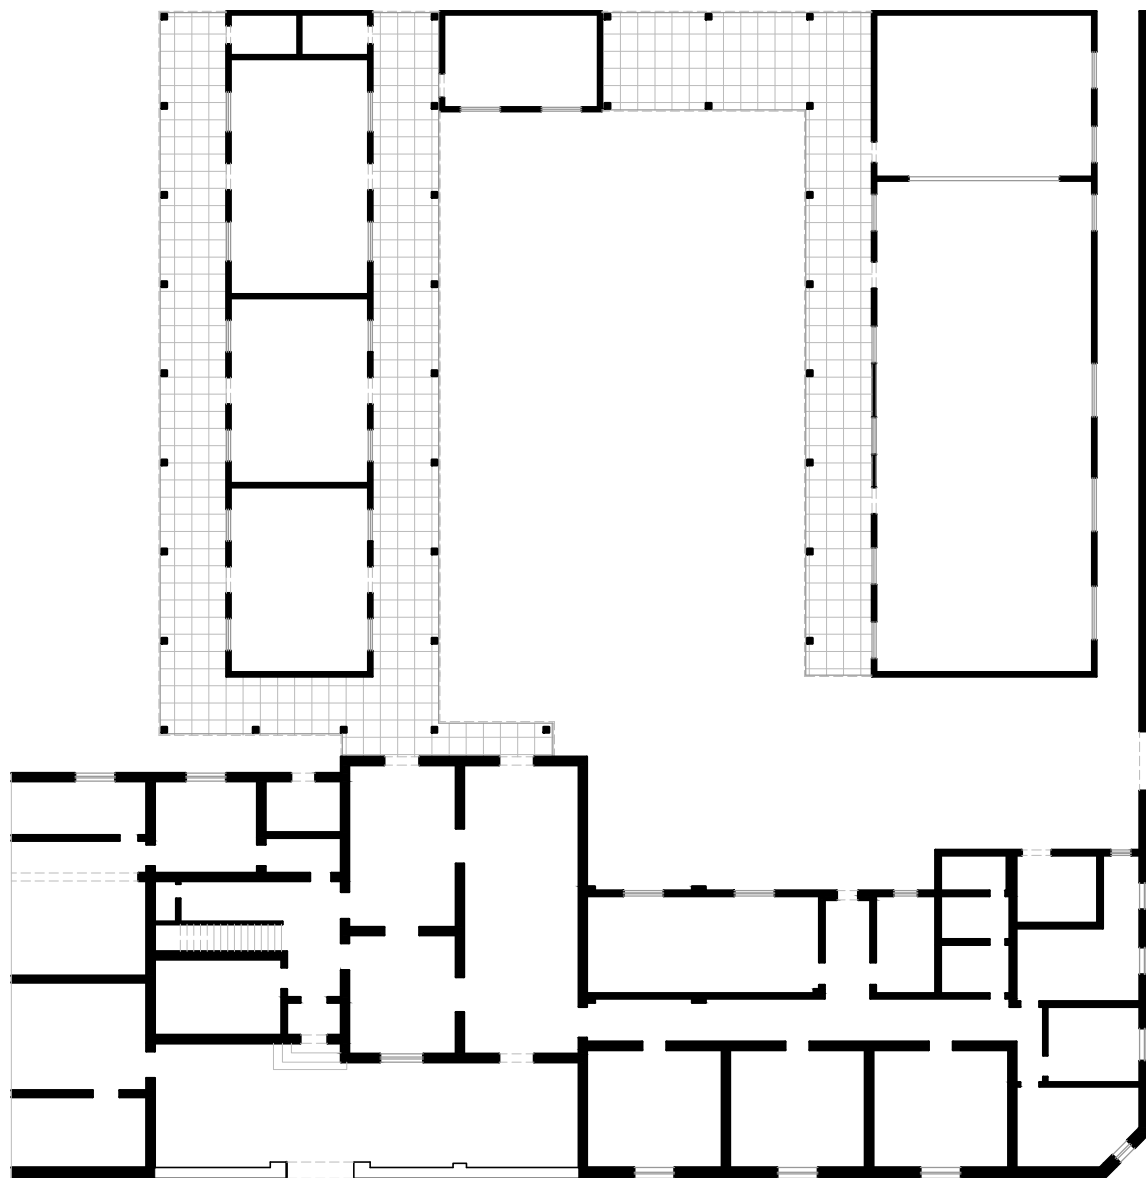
Quilmes High School for Girls*, planta baja.
